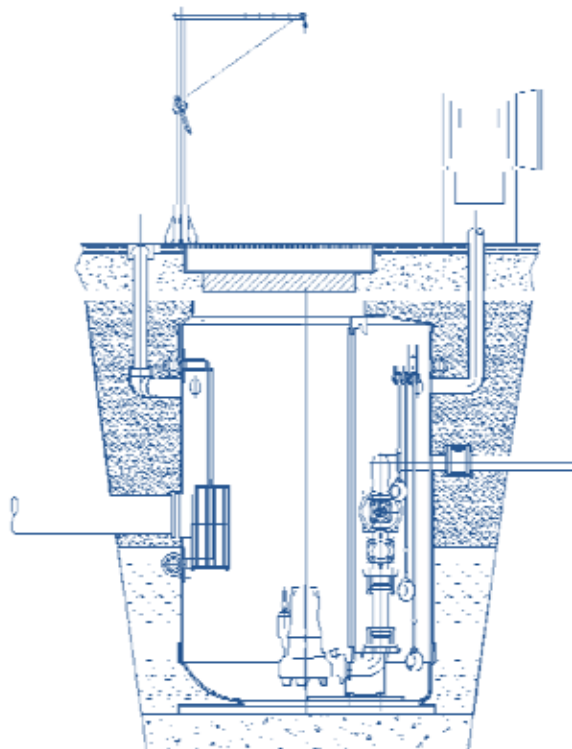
Exemple d'installation station sous chaussée avec robinetterie interne
